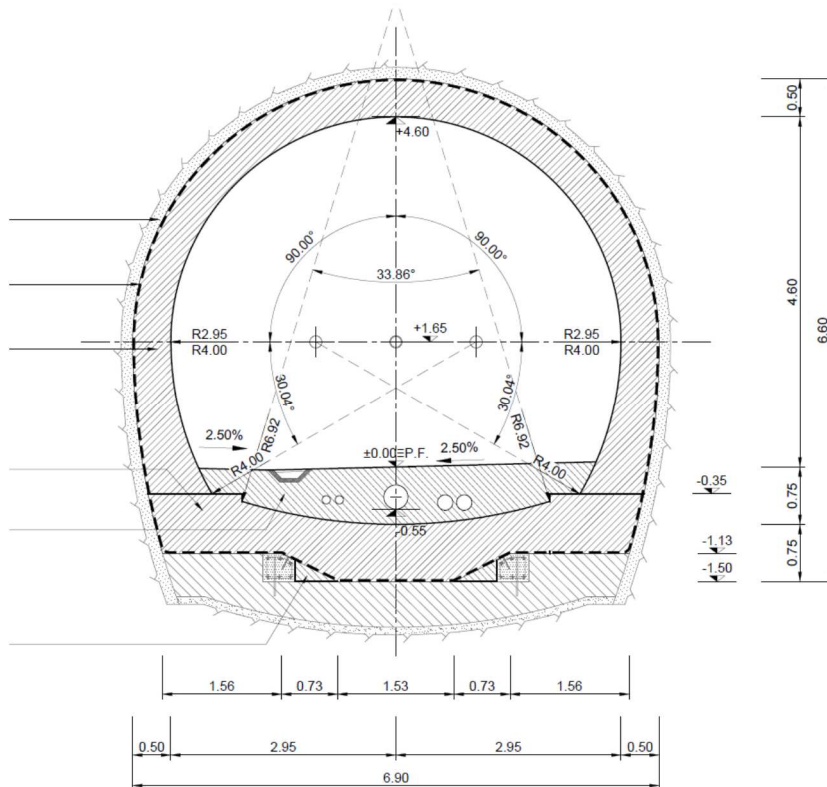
carpenteria tratta scavata in tradizionale – sezioni tipo T3 e T3p
